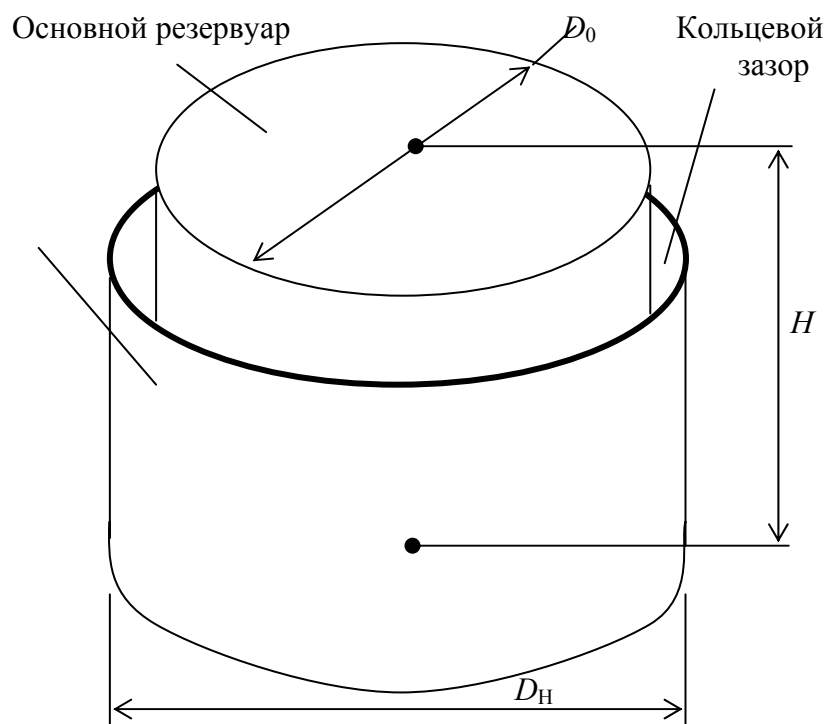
Вид вертикального цилиндрического резервуара с защитной кольцевой стенкой
